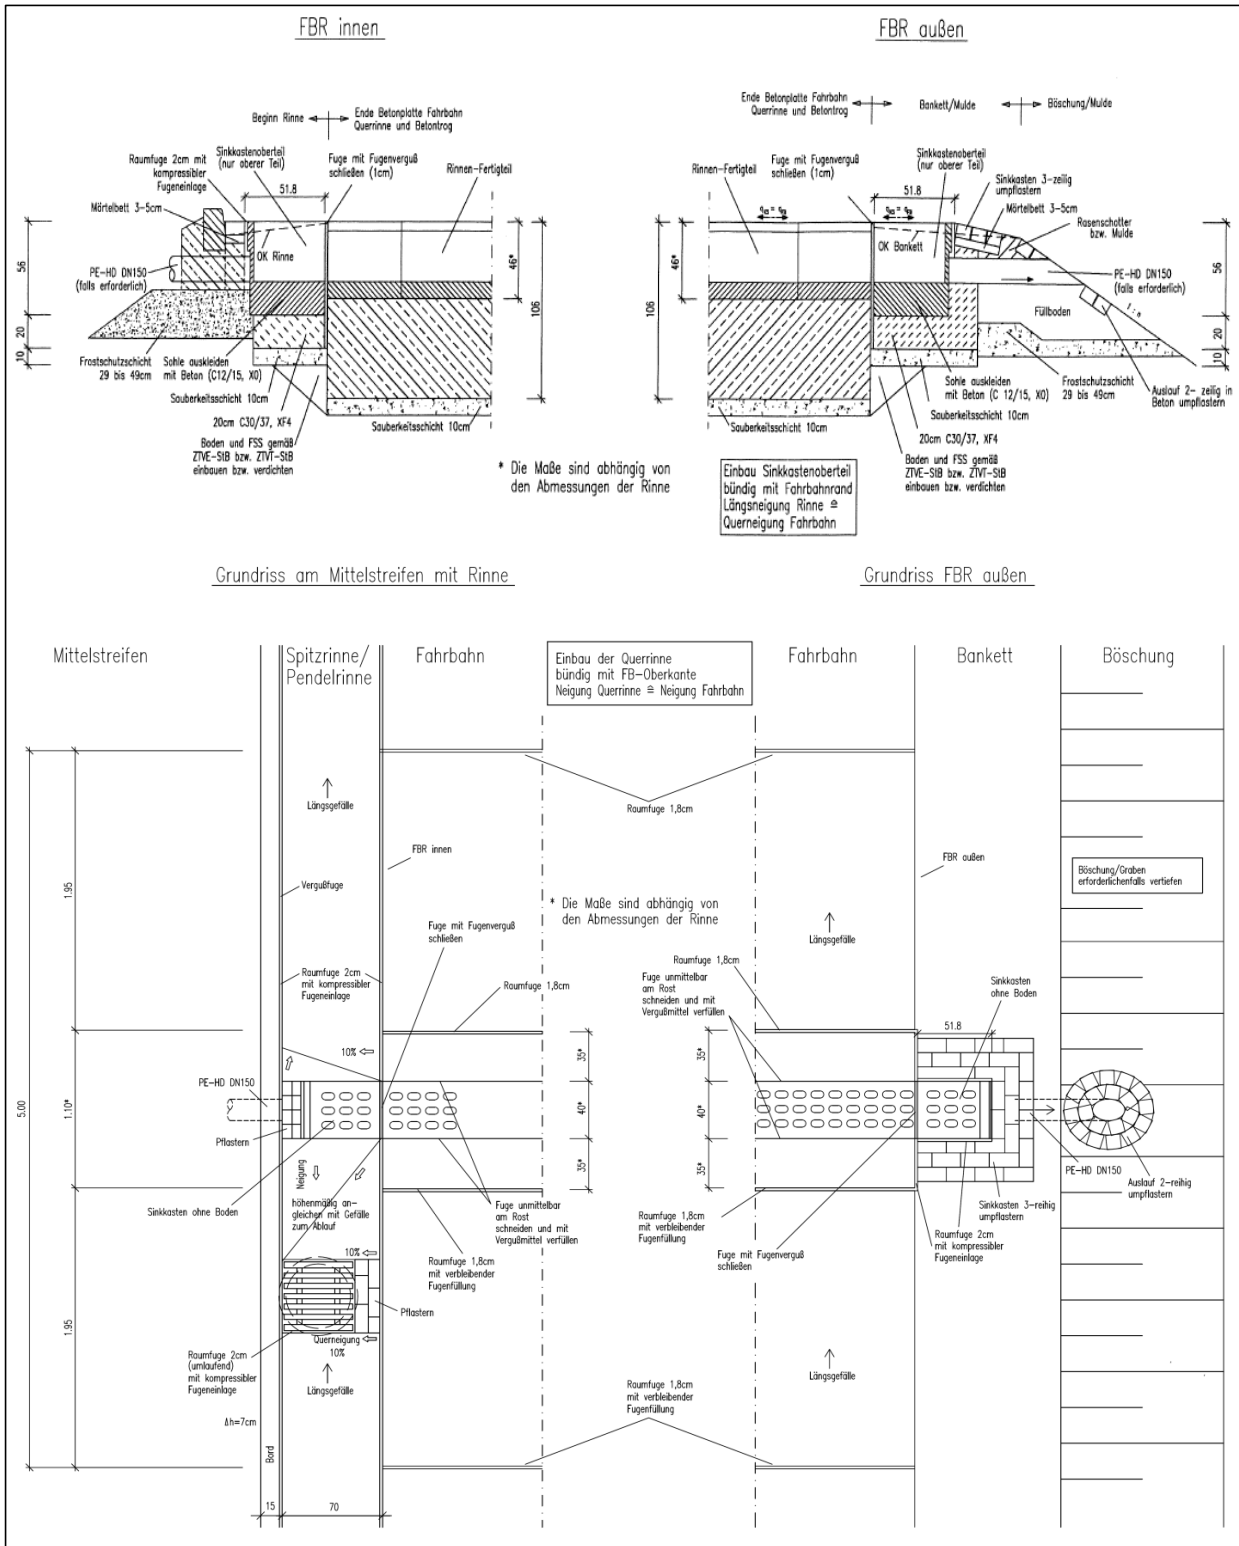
Einbaudetails zu Sinkkästen am Fahrbahnrand
